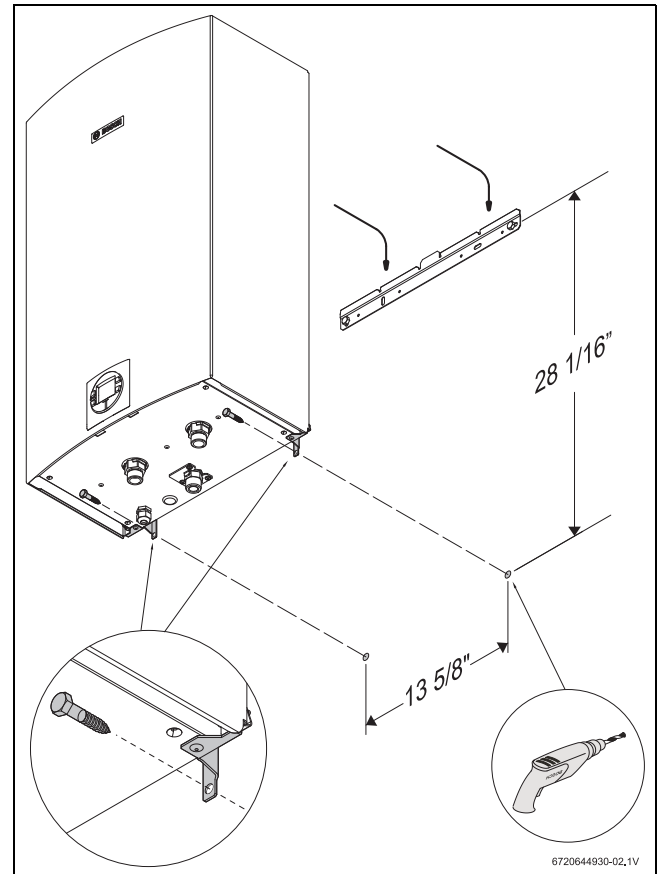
Montaje del calentador en casas prefabricadas (móviles)
